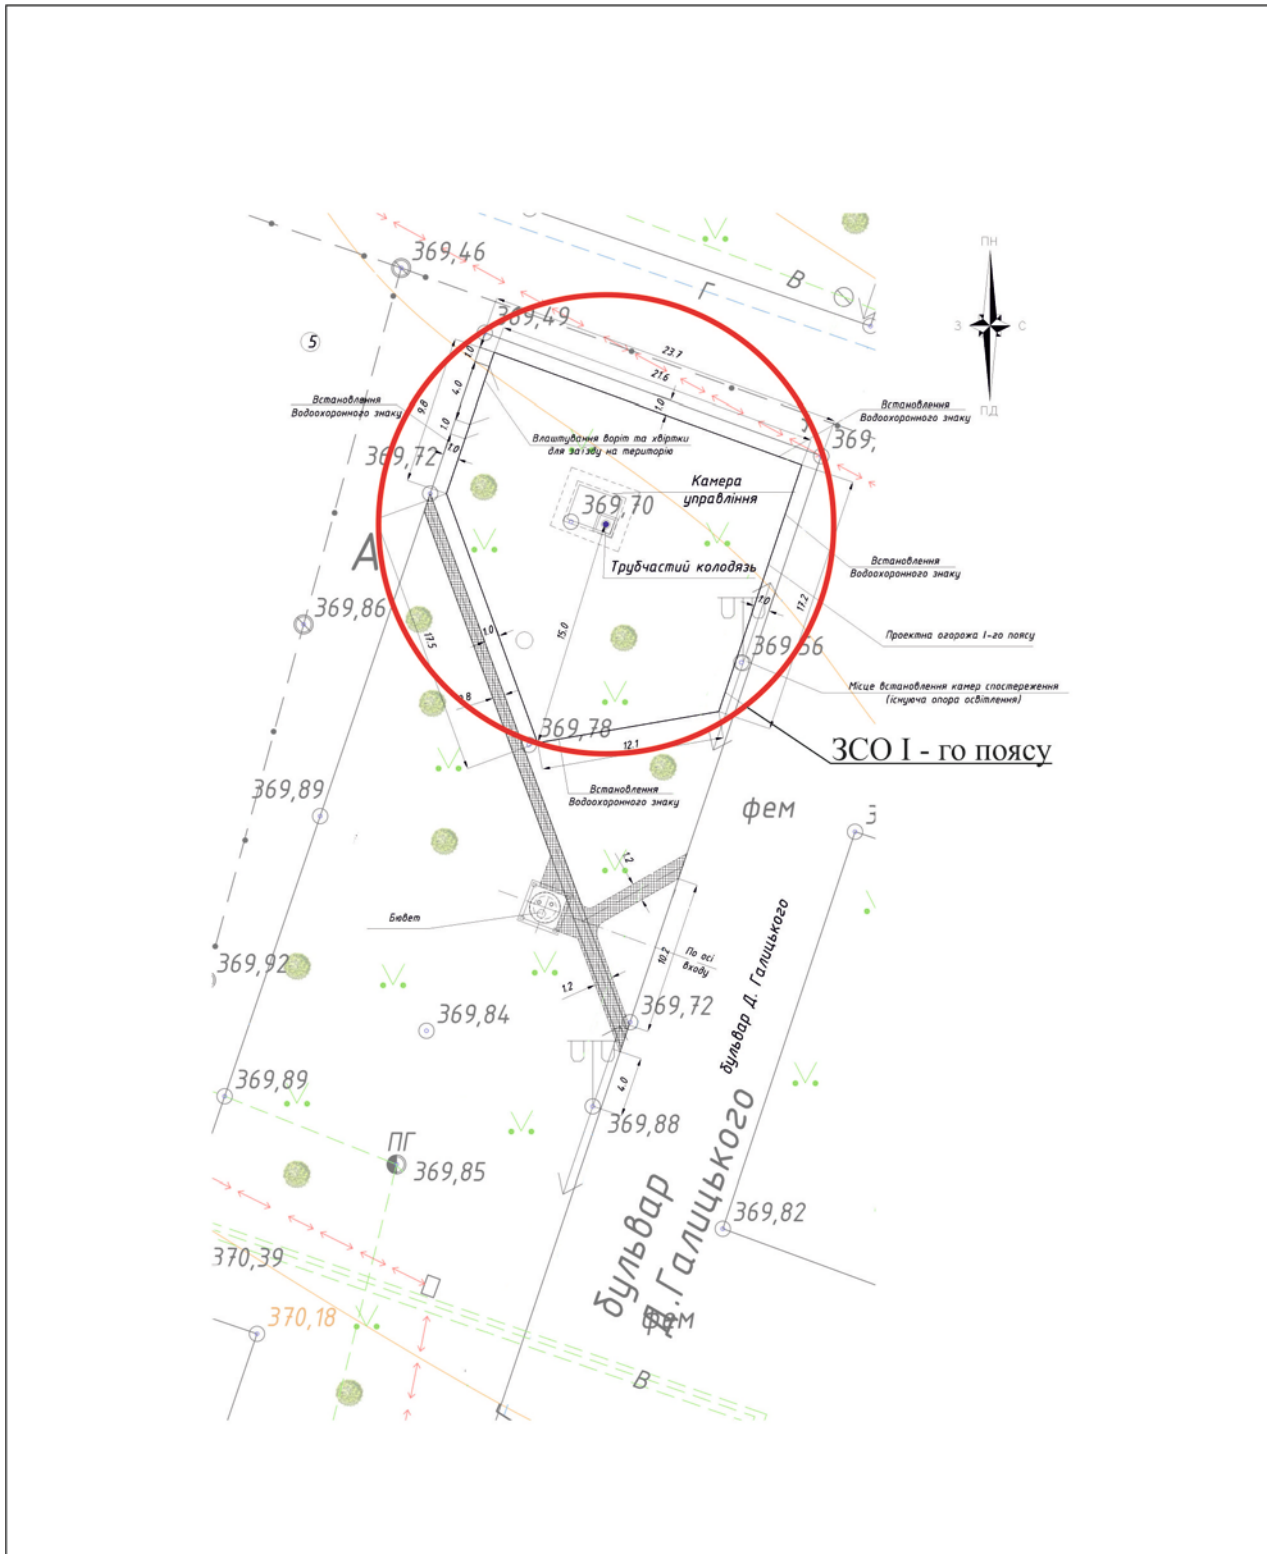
План першого поясу ЗСО свердловини (масштаб 1:500)
